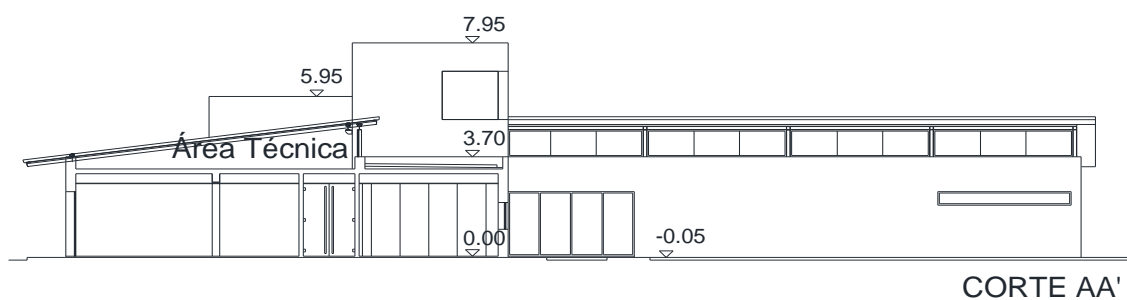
Corte AA' indicado na planta da fig. 36.
